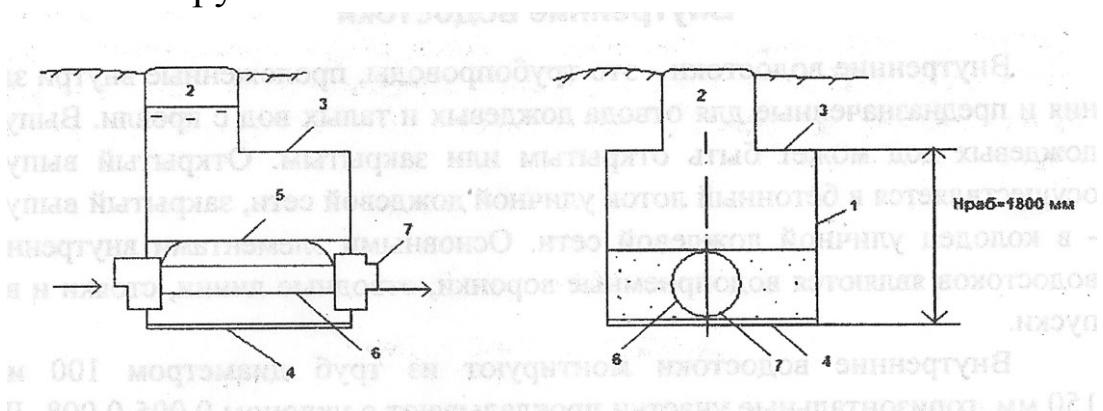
Канализационный колодец: 1 – рабочая часть $H_{раб}=1800$ мм, 2 – горловина (заканчивается вверху люком с крышкой), 3 – плита перекрытия, 4 – плита основания, 5 – монолитная бетонная берма (рабочая площадка), 6 – открытый бетонный лоток, 7 – трубы (подходящая и отходящая).
